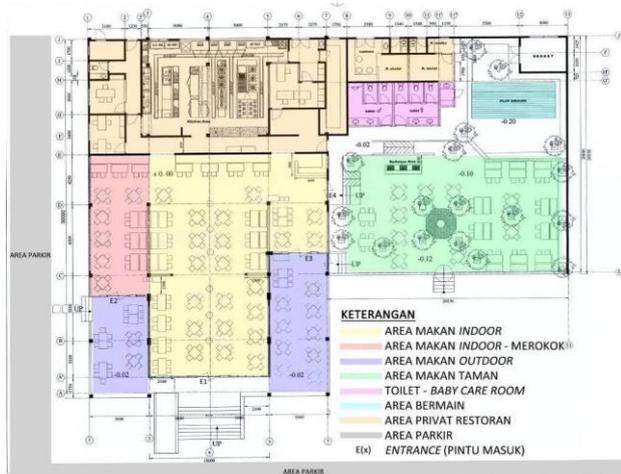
Denah Boncafe Pregolan Lantai 1
